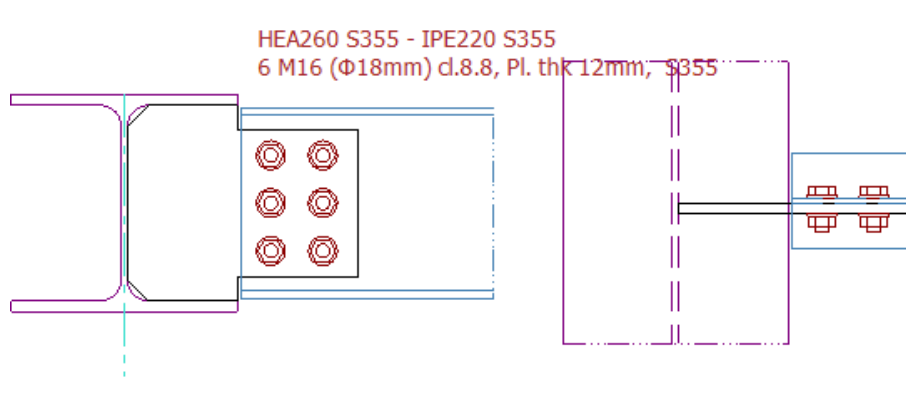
Ligação aparafusada do perfil HEA 260 ao perfil IPE 220
